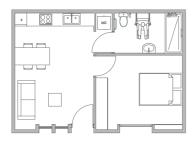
Planta Departamento Tipo A, Anteproyecto Fuente: Autores. 2022
